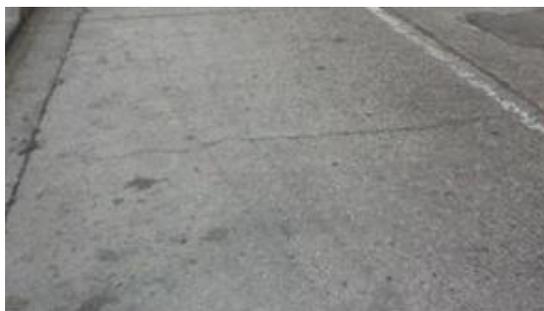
Grieta transversal en la calle Teodoro Maldonado⁶³
